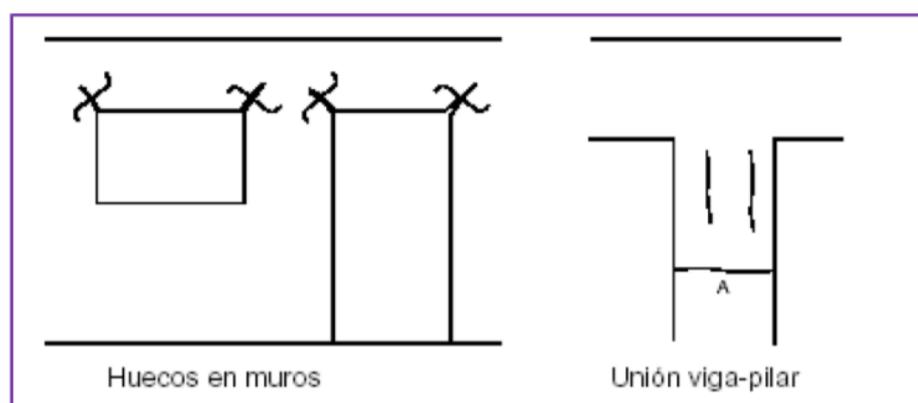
FALLAS EN EL ESTADO PLÁSTICO
